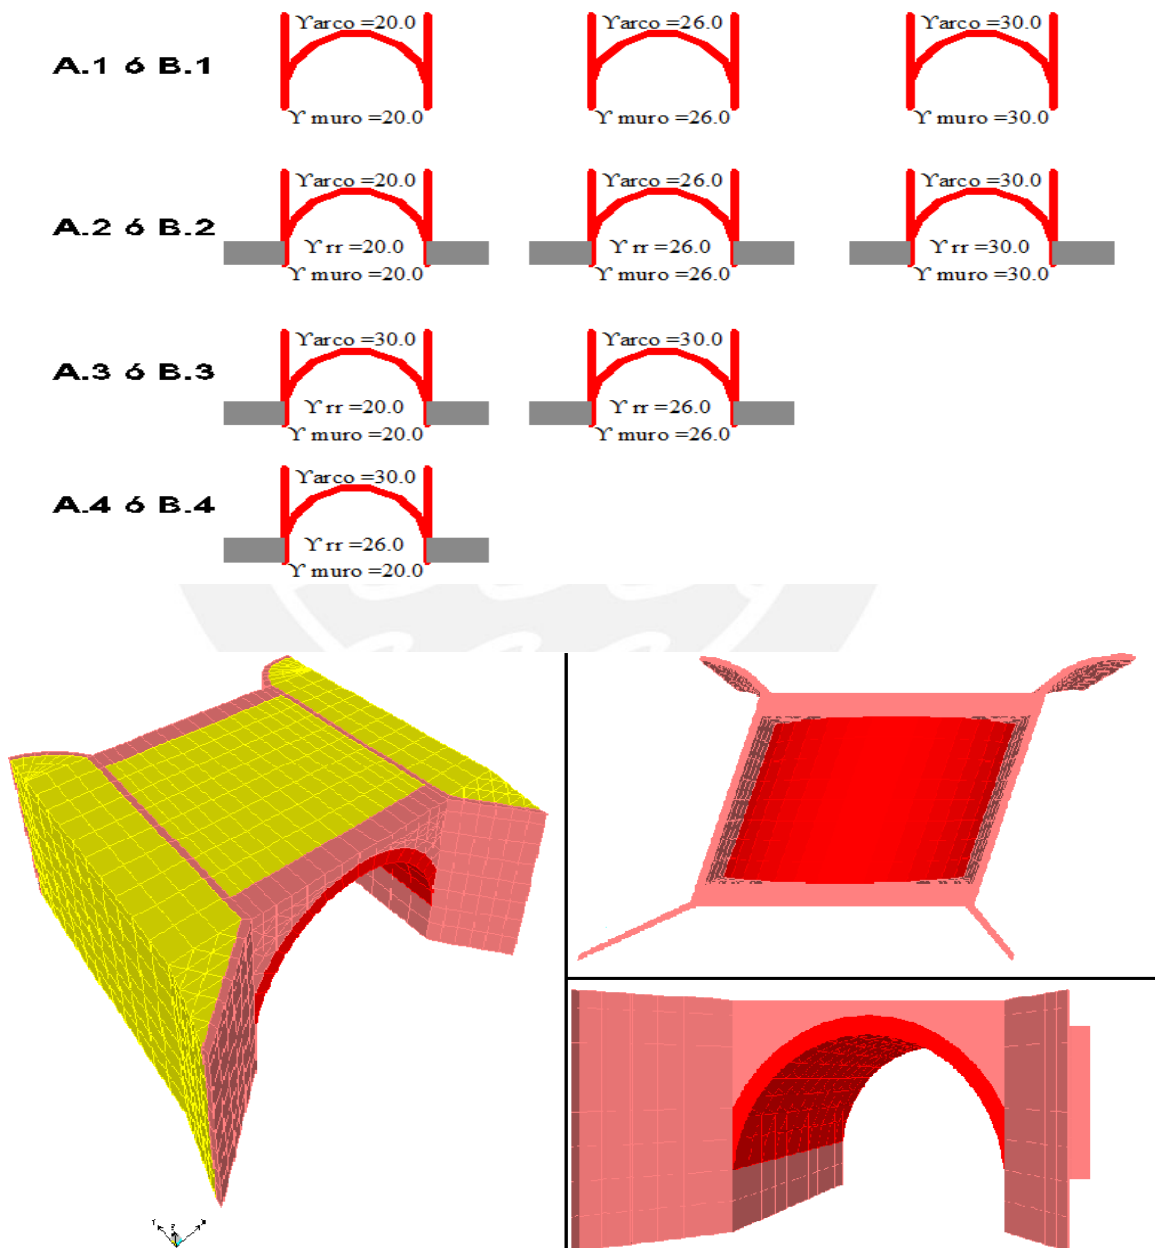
Modelo de elementos finitos de una bóveda del puente, (izq.) Vista en Isometría; (der. arriba) vista en planta; (der. abajo) vista en elevación.
